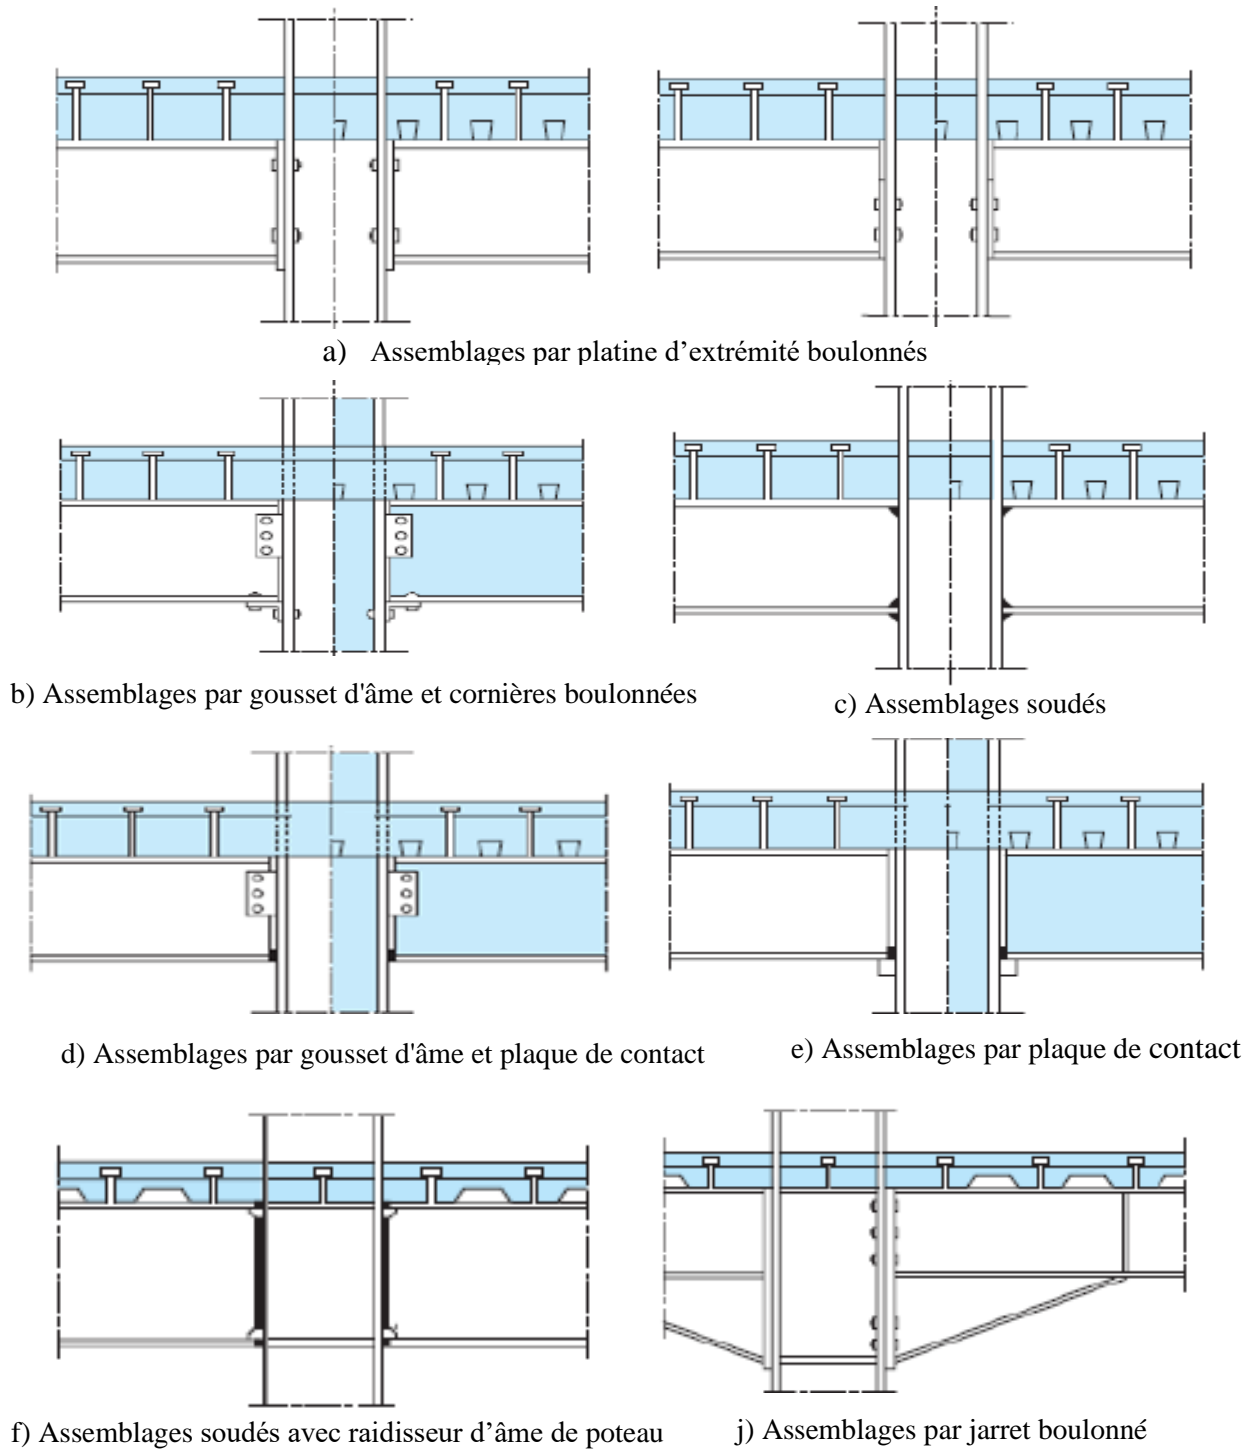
Types usuels d'assemblages mixtes de type poutre-poteau [30].
